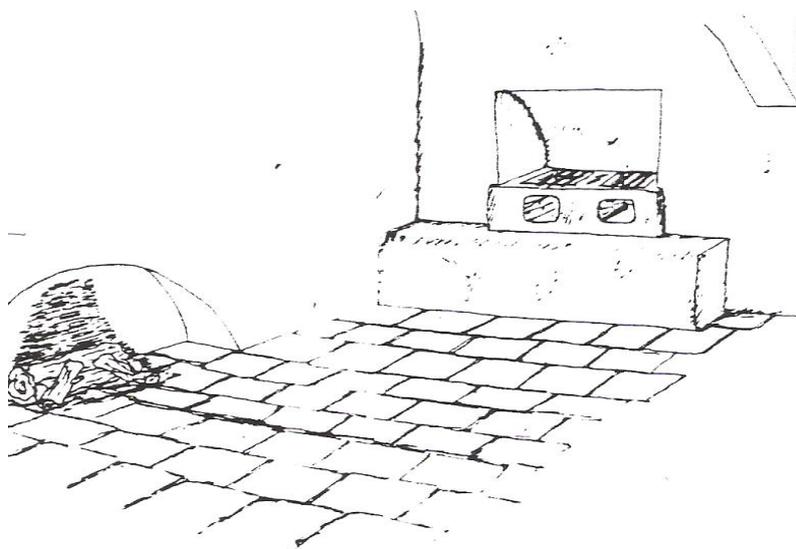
Exemplo de pavimento de tijoleira (baldosa) [11]
